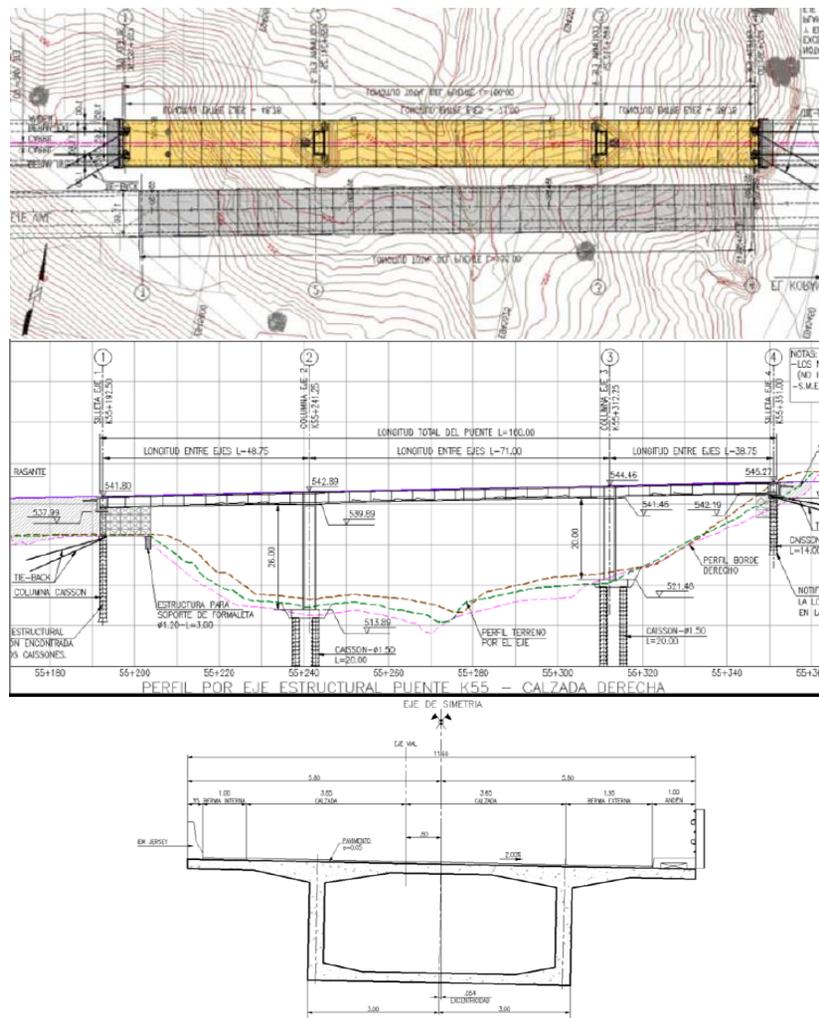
8. Planta y perfil del puente K55 (Voladizos Sucesivos) - Calzada Derecha. Fuente: (AGENCIA NACIONAL DE INFRAESTRUCTURA, 2010)
